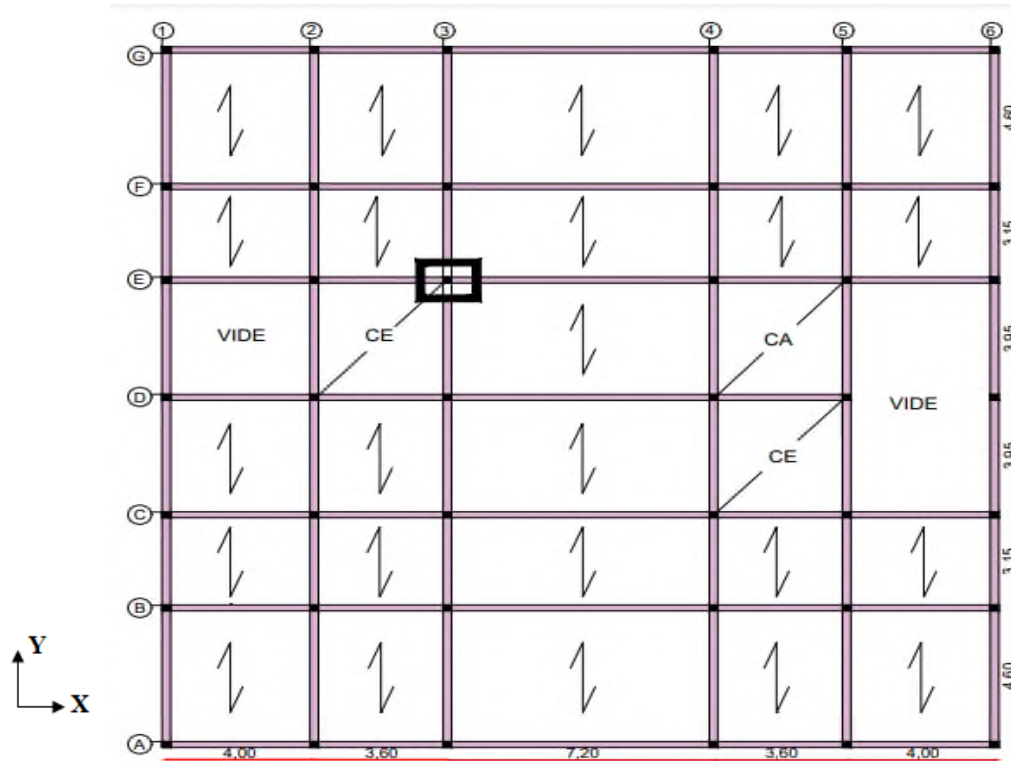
Disposition des poutrelles des planes 2^{èmes} aux 9^{ème} étages.
